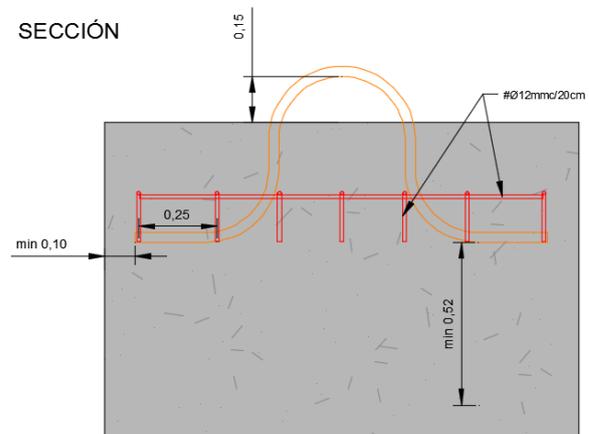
Detalle de arganeo y armado de enganche de muerto de amarre
